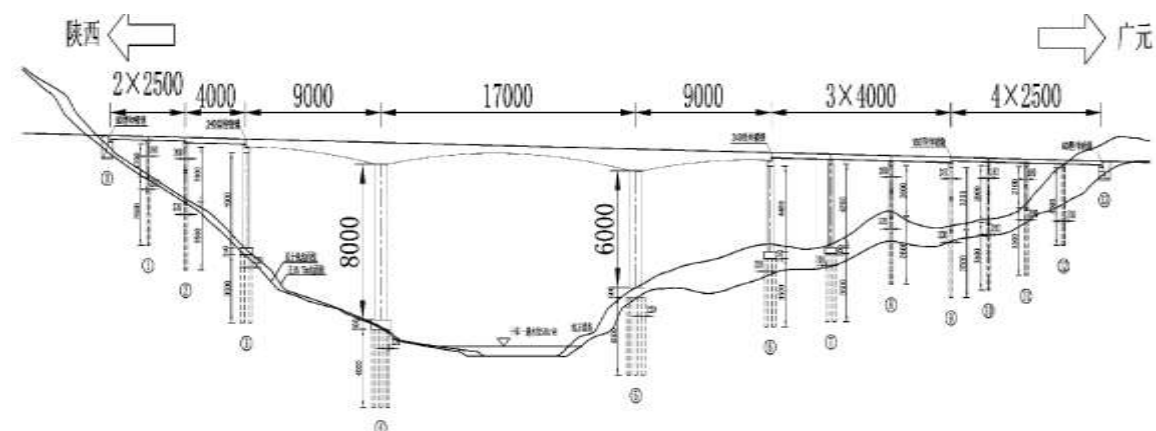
(a) 南河一号特大桥（左幅）立面布置图
